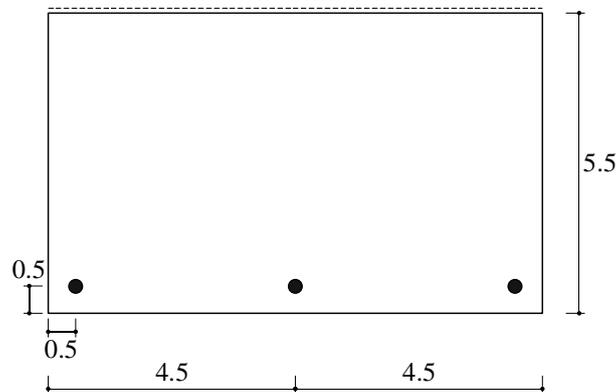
Abmessungen und statisches System der behandelten Platte. Abmessungen in m.
